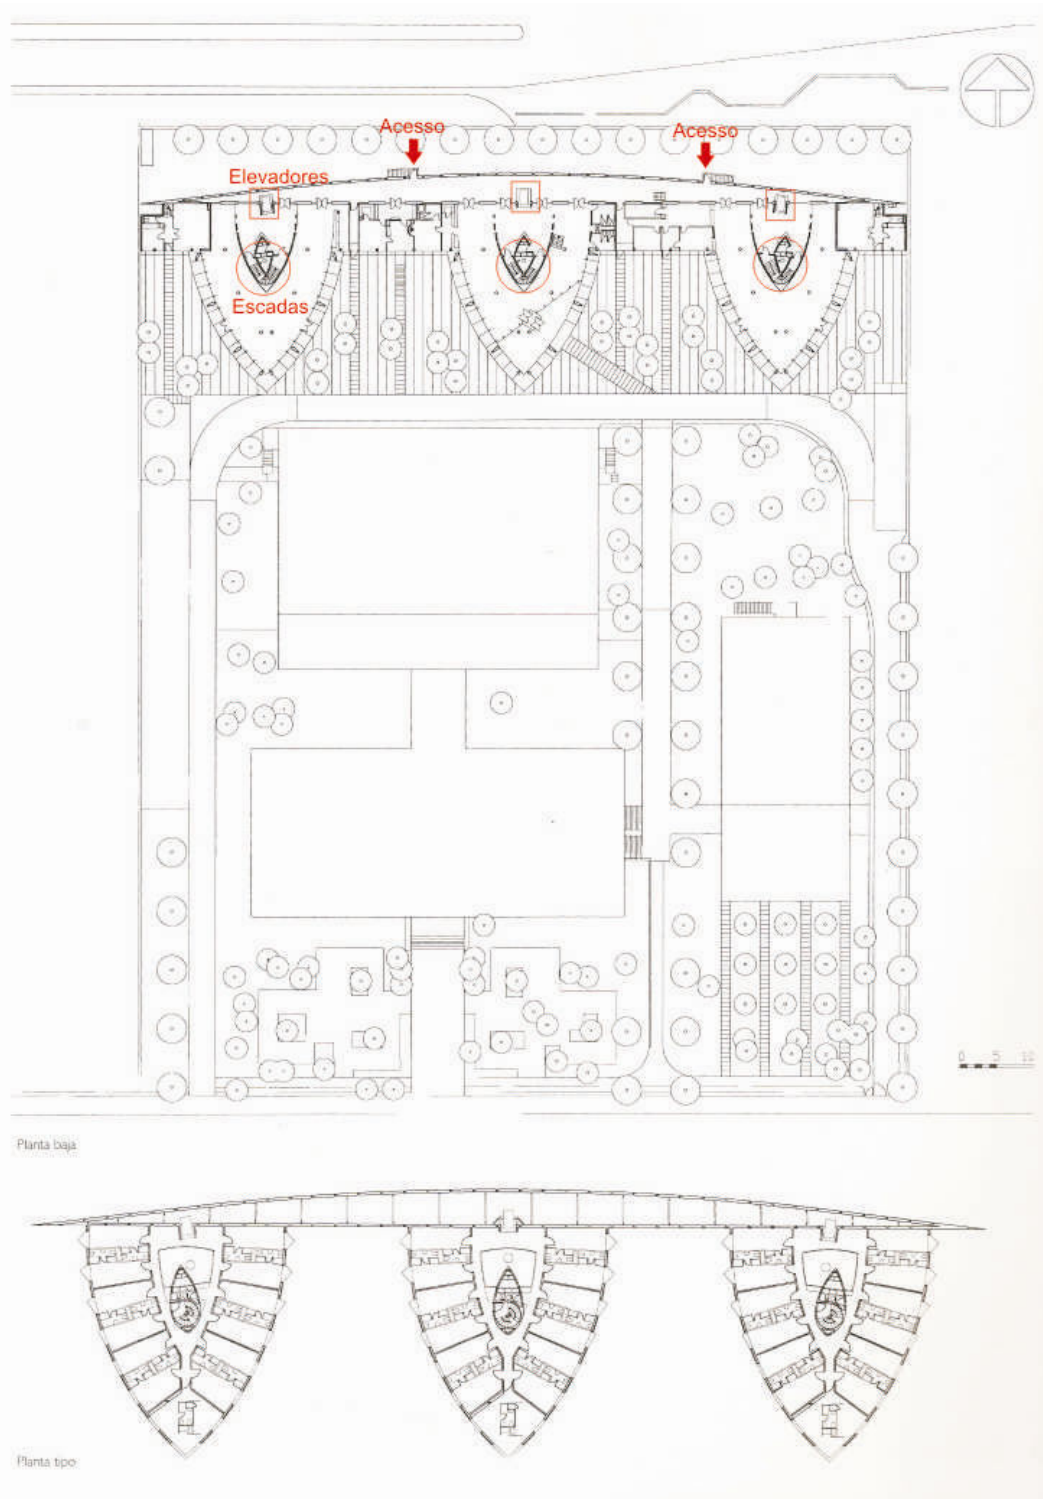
Planta baixa térrea e tipo do University Residence. (HUBER, Wilhelm)
